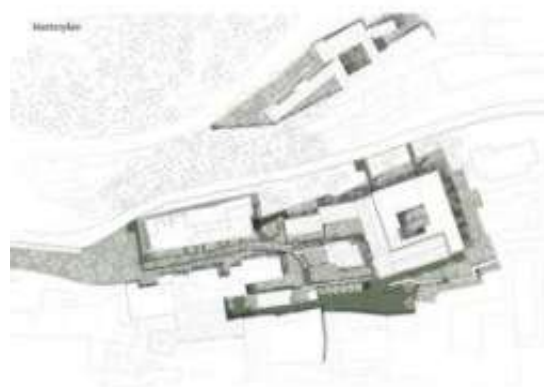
Masterplan di progetto (elaborazione dell'autore).
